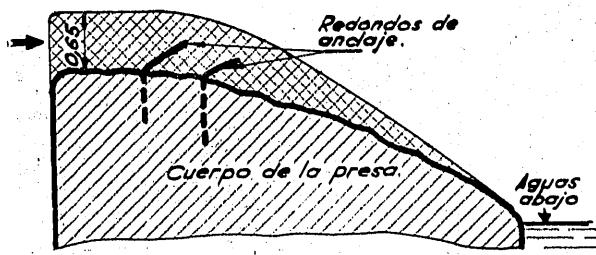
Reecrido de presa que, a pesar de anclajes de hierro, se marchó a la primera crecida por haberse descuidado la junta de trabajo. Reecrido de hormigón sobre vieja mampostería.
